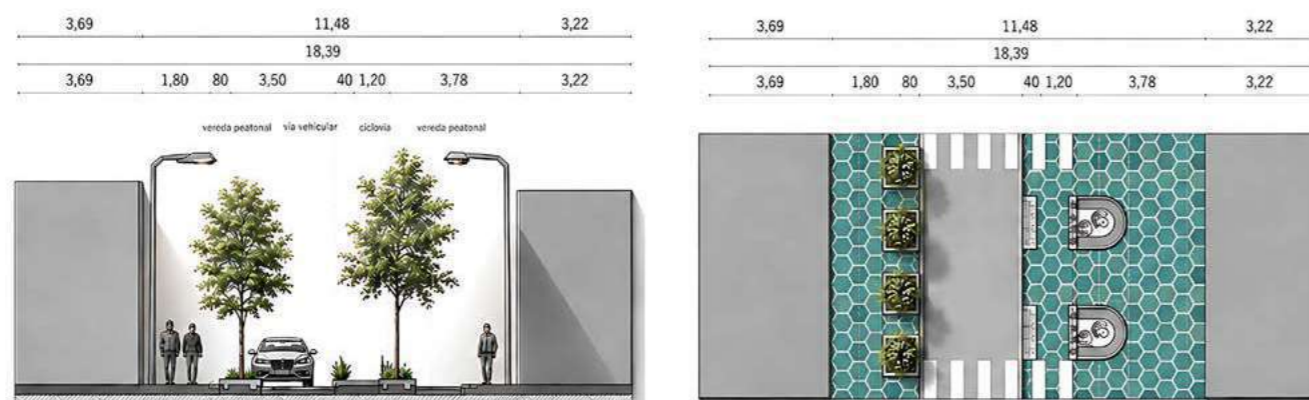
Sección y planta propuesta en la calle Rafael María Arízaga. Elaboración propia.
